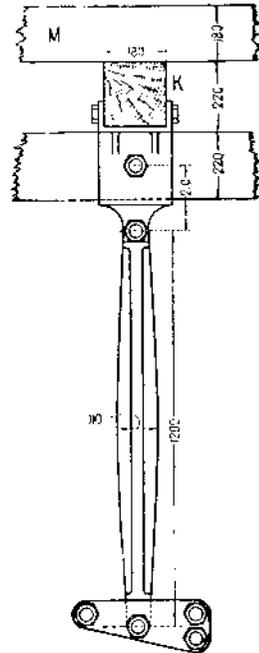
представляет собою общий вид фермы той же системы с деревянным верхним поясом для пролетов до 16 м. На фиг. 230, 231, 232, 233 показаны детали этой фермы со всеми необходимыми размерами. Существенную часть конструкции фермы составляют чугунные башмаки на опорах и в коньке, в которые вставляют концы деревянных стропильных ног.
